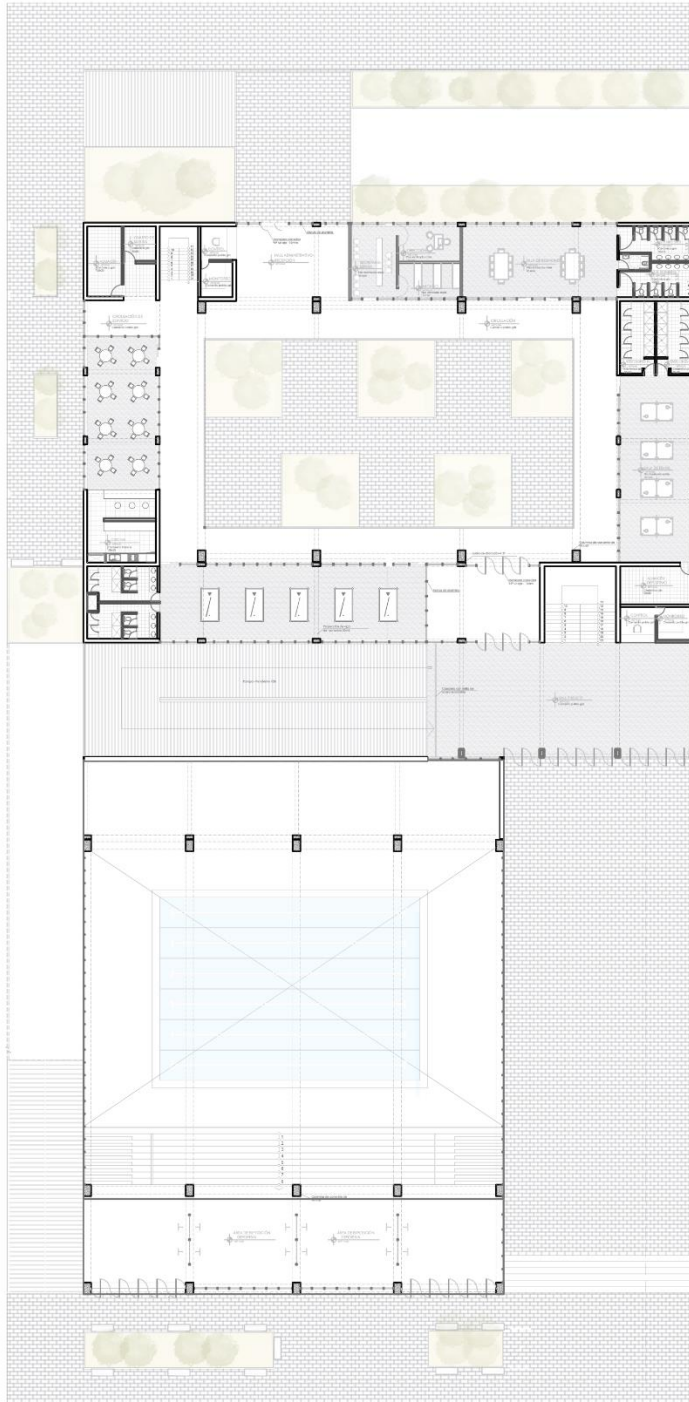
Infraestructura deportiva planta segundo nivel, fuente; propia
